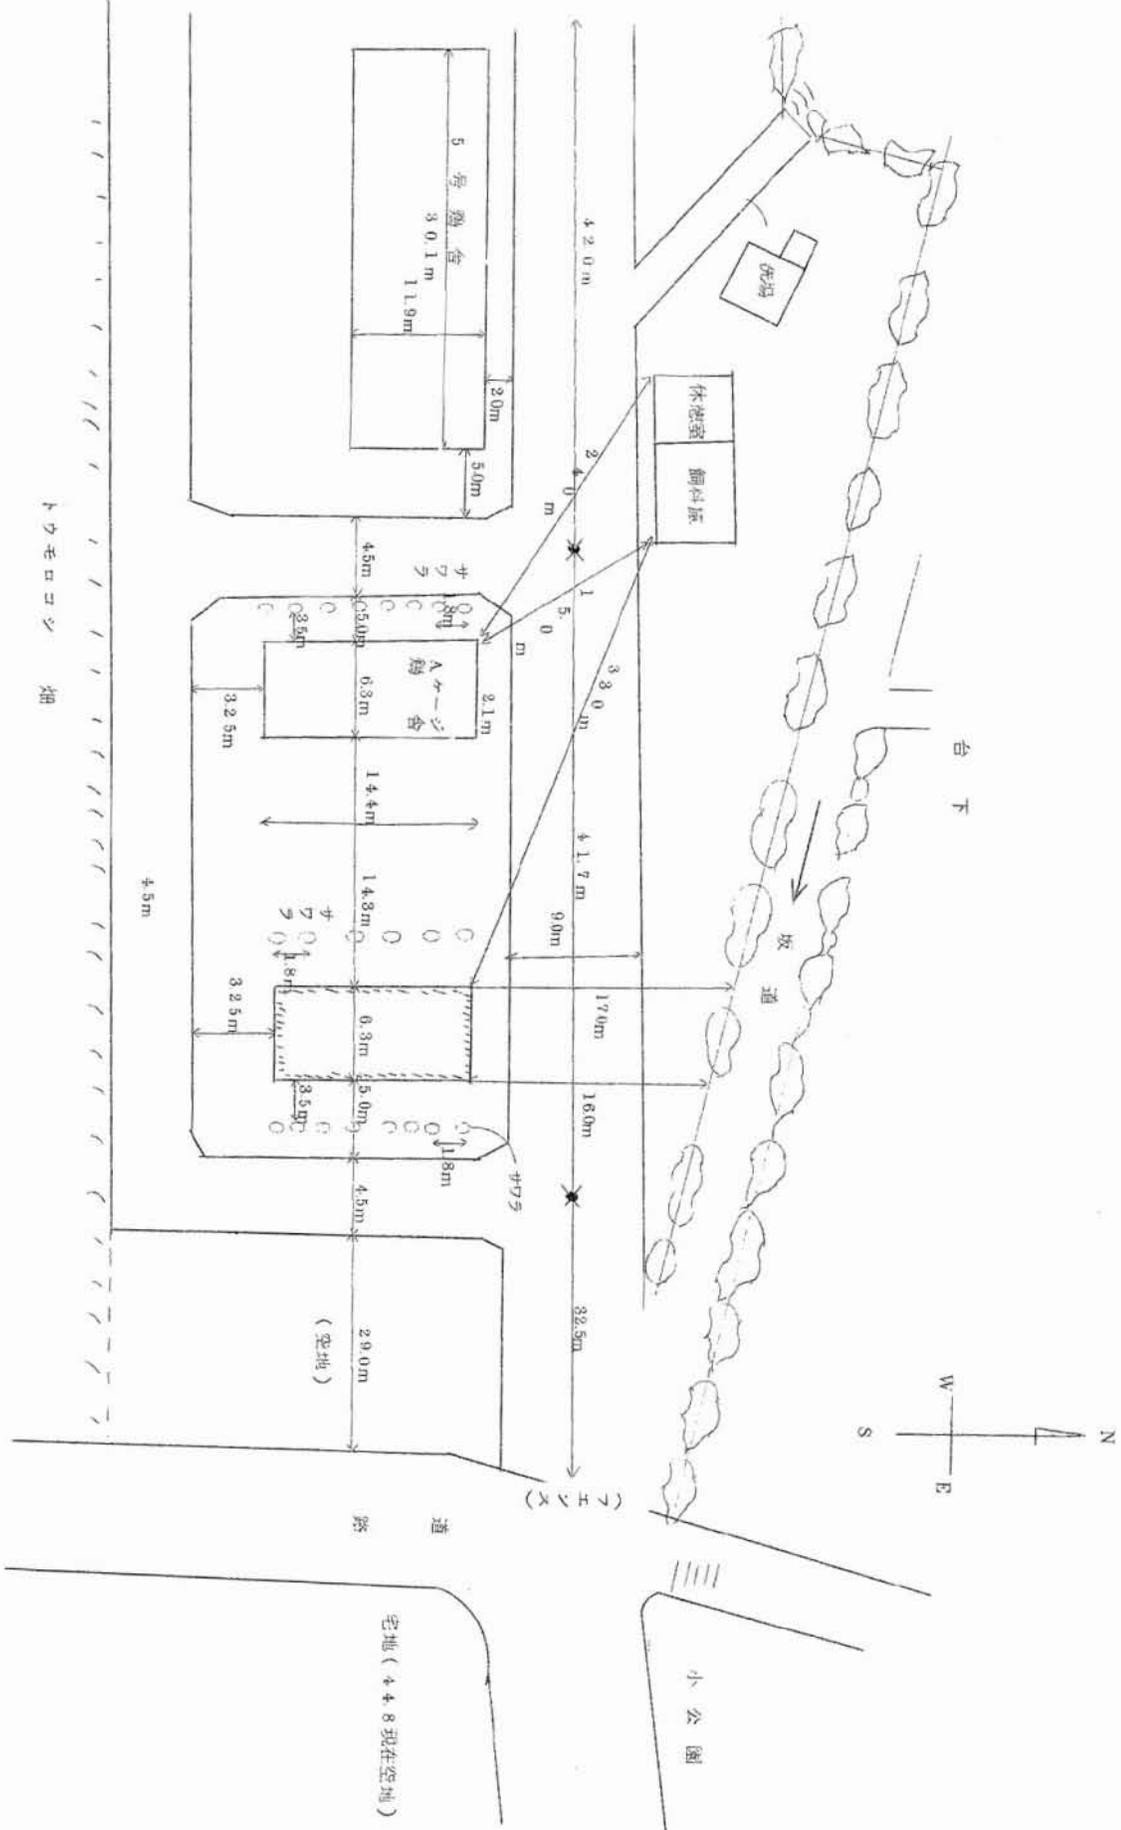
鶏舎配置図 (Aターゼ舎, Bターゼ舎及び5号鶏舎) (単位: m)
